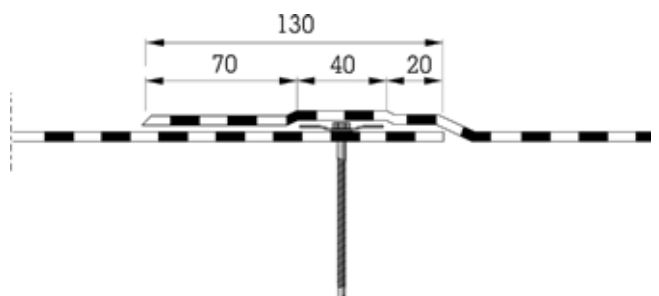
Joint longitudinal en cas de fixations mécaniques
